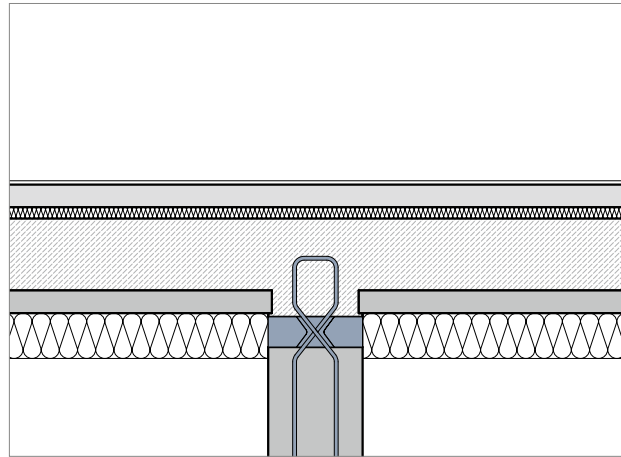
Schematische Darstellung Schöck Sconnex® Typ W bei Halbfertigteildecken und Unterdeckendämmung
